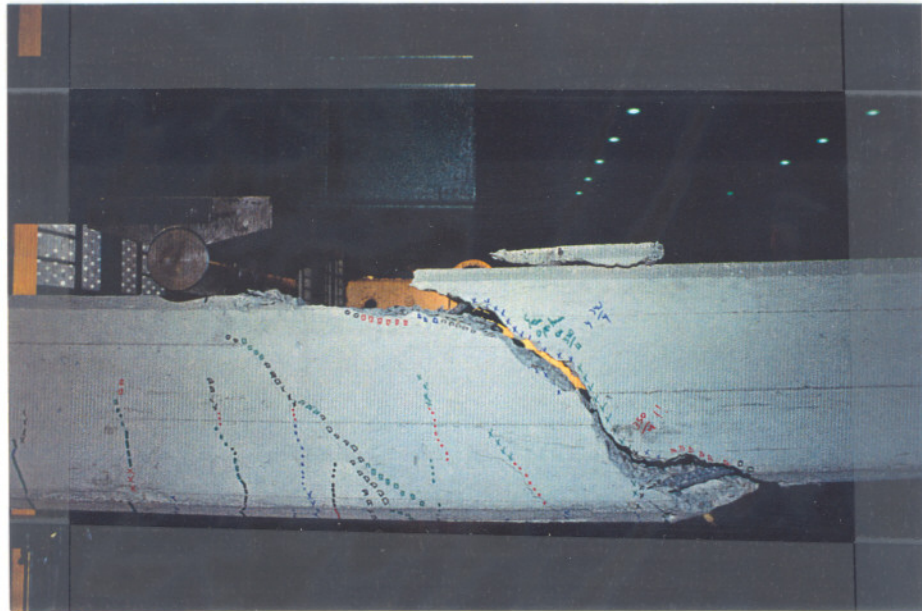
Detalle de la rotura de la viga C22. El ancho de la grieta fue tal que podía verse el otro lado de la viga.
